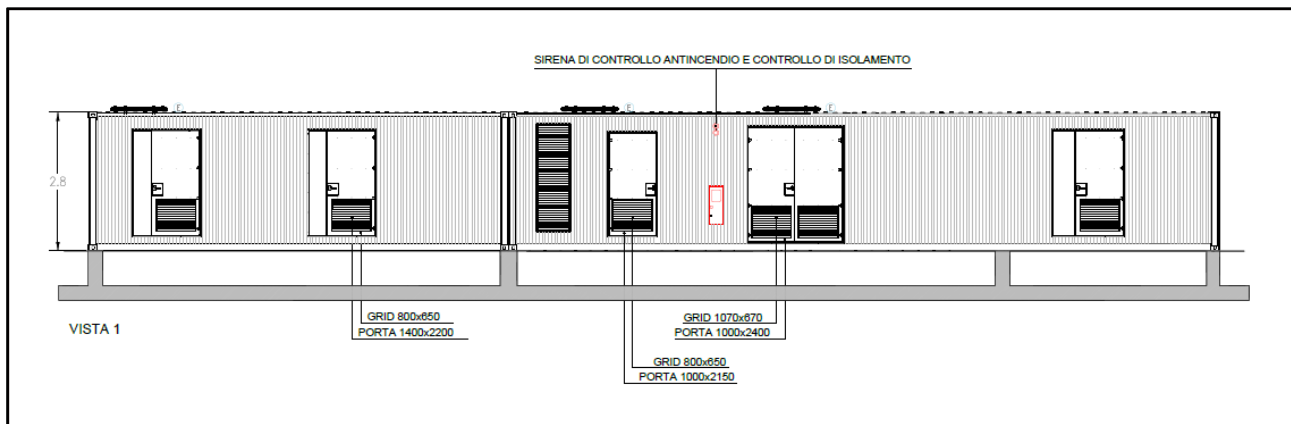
Cabina elettrica e di smistamento – Prospetto
